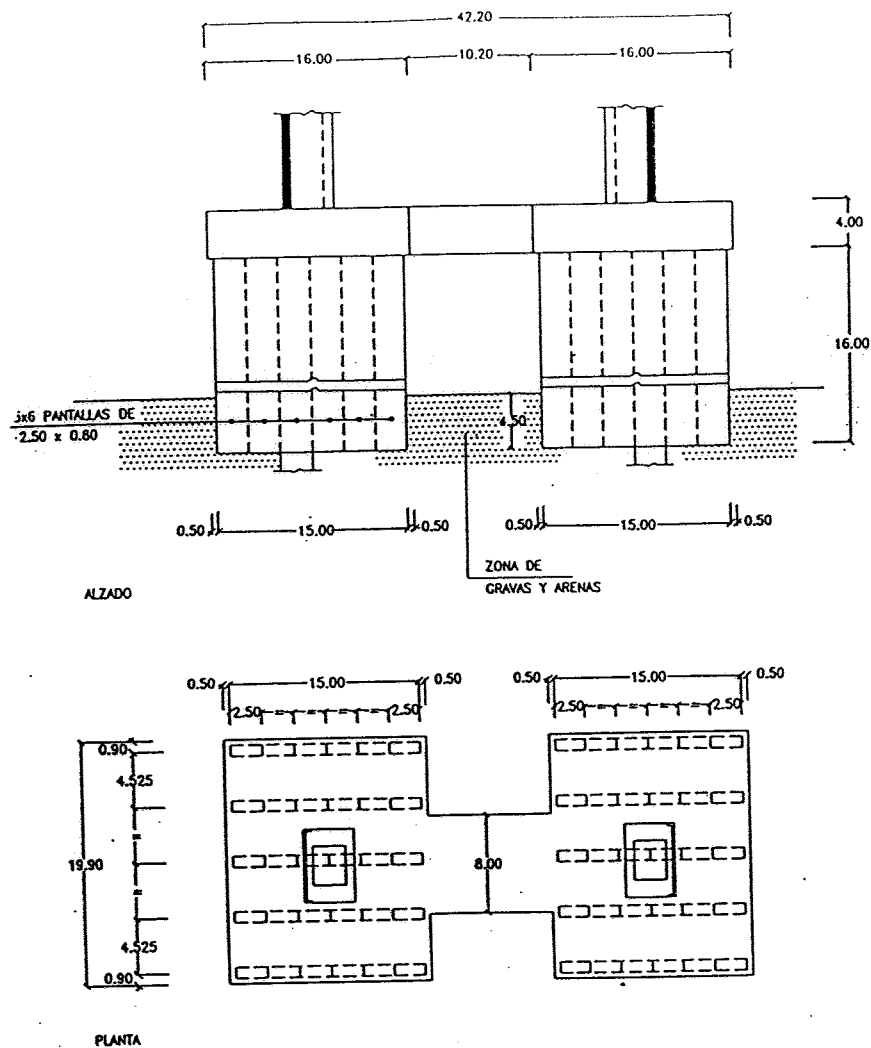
Cimentación de las pilas principales del Puente V Centenario (Sevilla) mediante elementos portantes.
